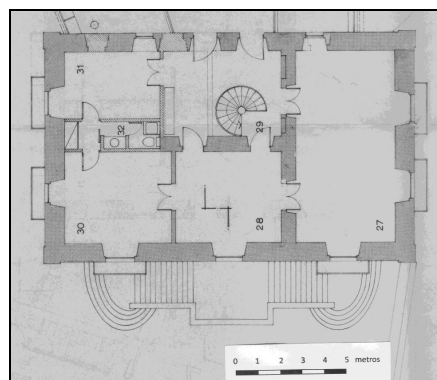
Casa de câmara e cadeia da Lagoa – planta do piso de entrada.
